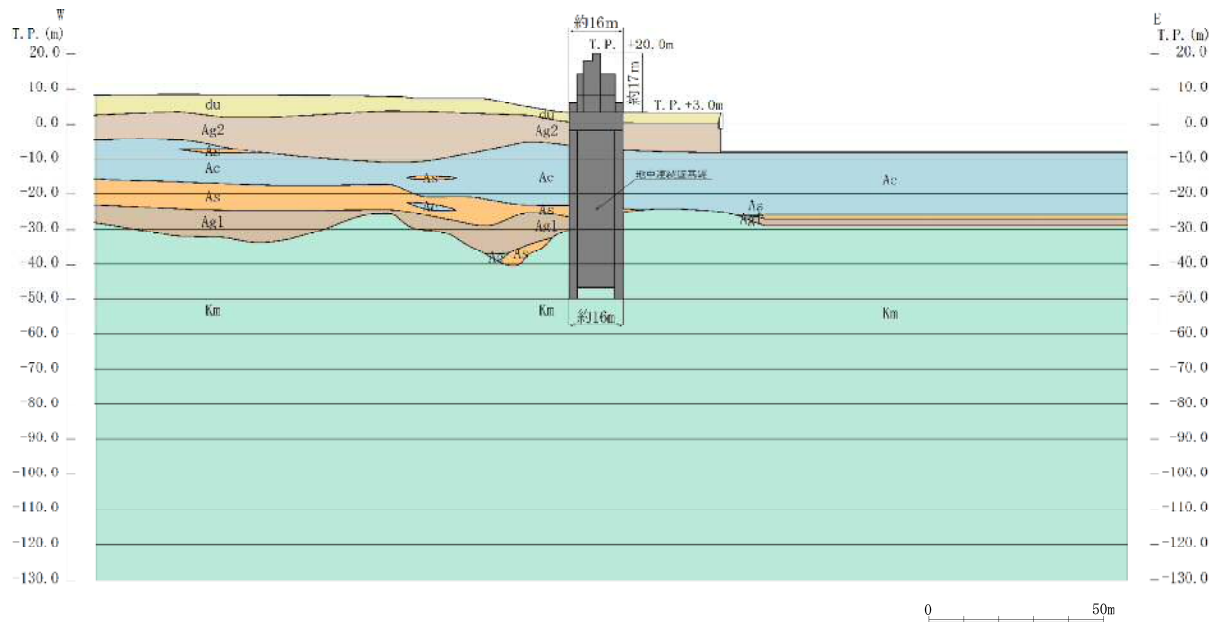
(3) 鋼製防護壁 評価対象断面図 (③-③断面)
